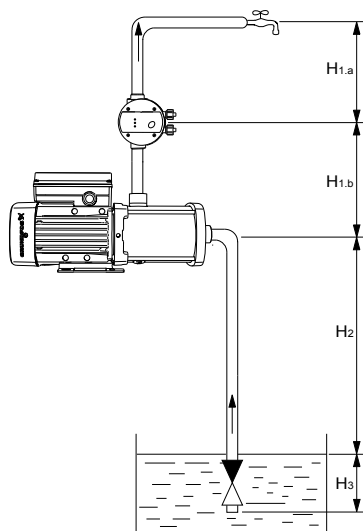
Самовсасывающая установка повышения давления CMB-SP SET
